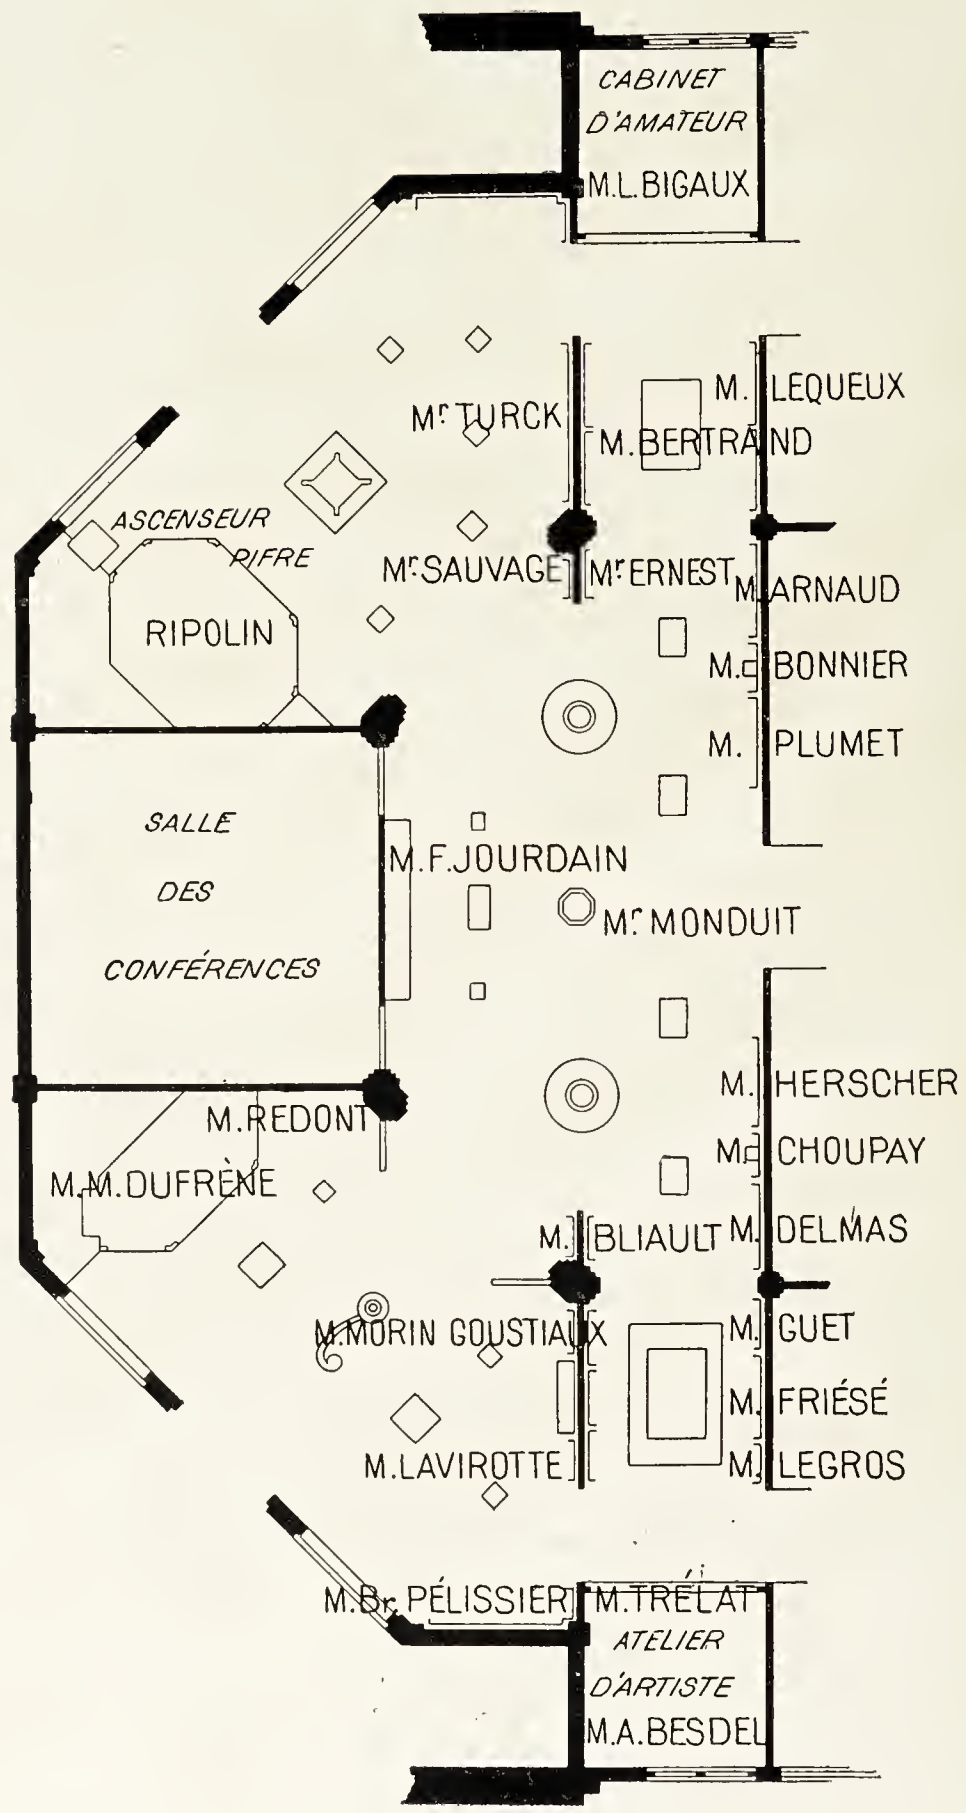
Plan du Groupe VIII. — Classe 66.
